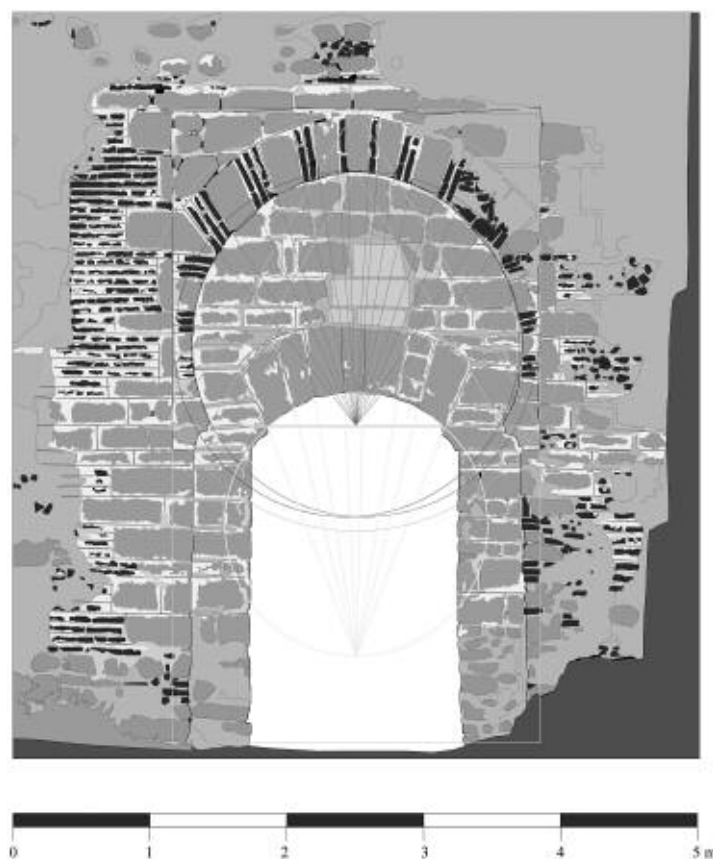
Alzado fotogramétrico de la fachada del Postigo de la Coracha en la Alcazaba de Badajoz, con su correspondiente trazado geométrico.
